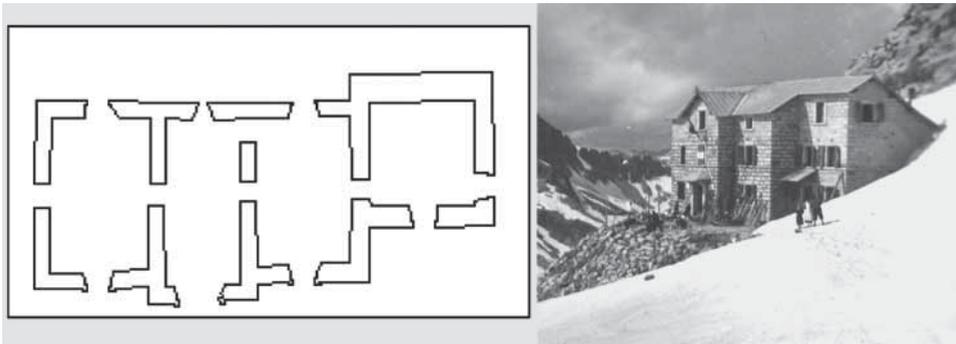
Il rifugio dopo il 1933, pianta e foto (Archivio C.A.I. di Brescia).
